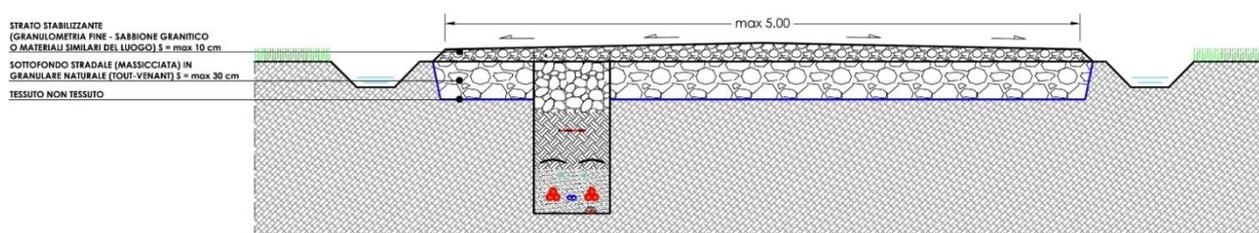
Viabilità di Progetto: Sezione Tipo (Elab. SP TAV 6 Particolari viabilità di progetto tipo e cavidotti)
